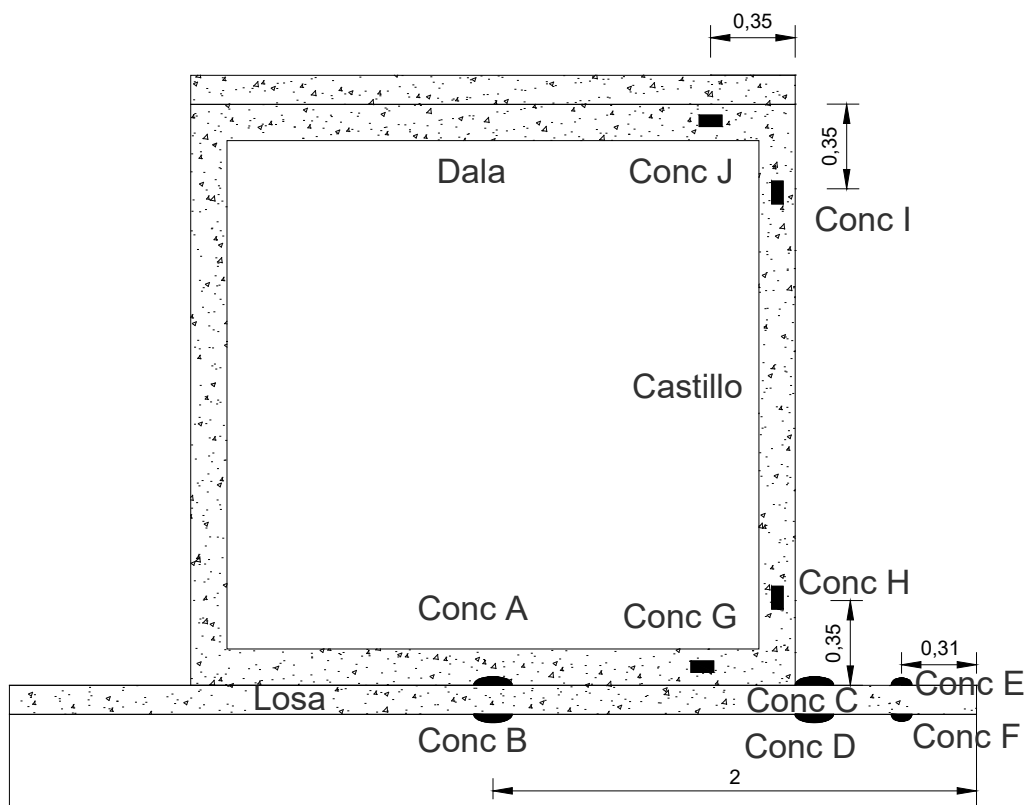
Localización de strain gages de concreto en dala, castillo y losa (Vargas 2014)
